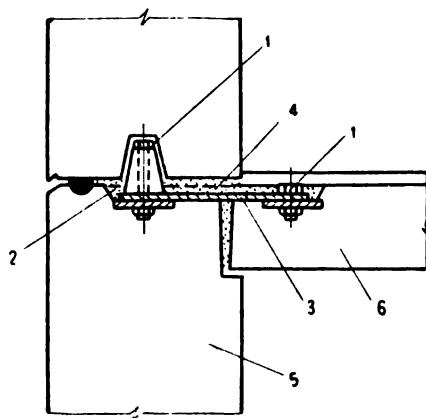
Болтовая связь между панелями стен и перекрытий в доме серии П-57
